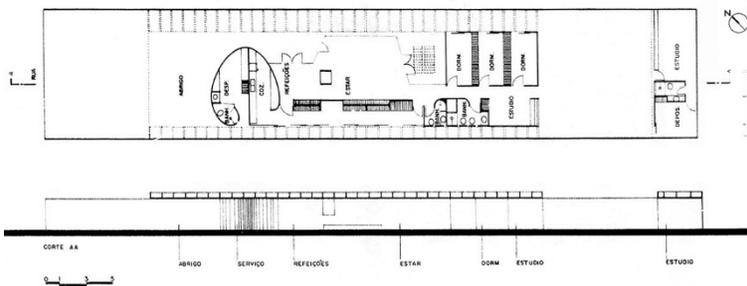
Casa Chyio Hama. Situação planta e corte.
